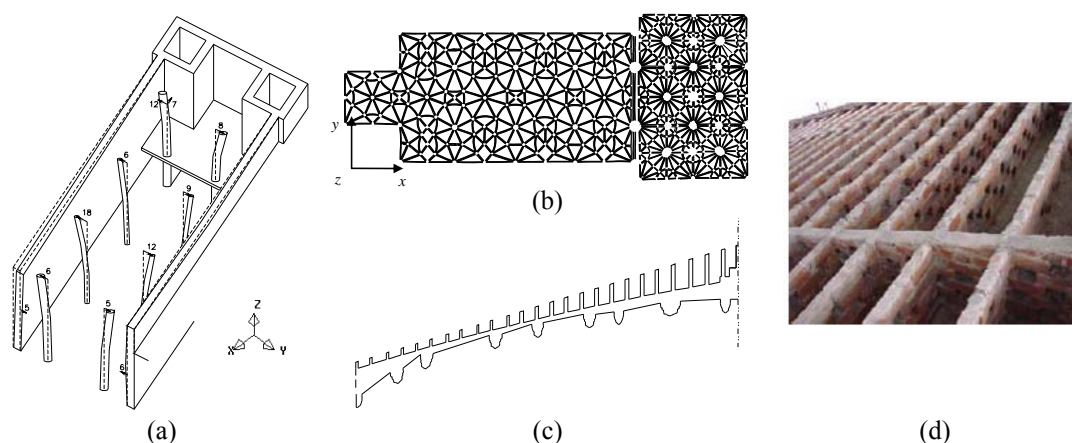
Levantamento de aspectos geométricos da nave: (a) deformações nos pilares e paredes exteriores; (b) planta da abóbada; (c) meia secção transversal da abóbada; (d) paredes de alvenaria no extradorso da abóbada para assentar as telhas da cobertura.
